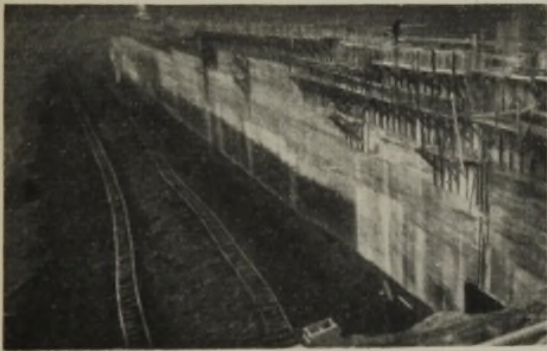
Betonkern des Staudammes Odertalsperre im Harz mit Bitumenanstrich.
